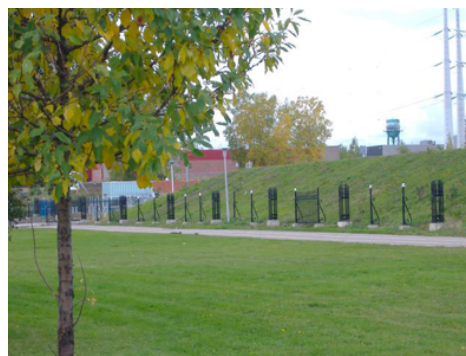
Octobre 2009: construction de la clôture qui fermera ce qui était auparavant un espace ouvert et accessible.
